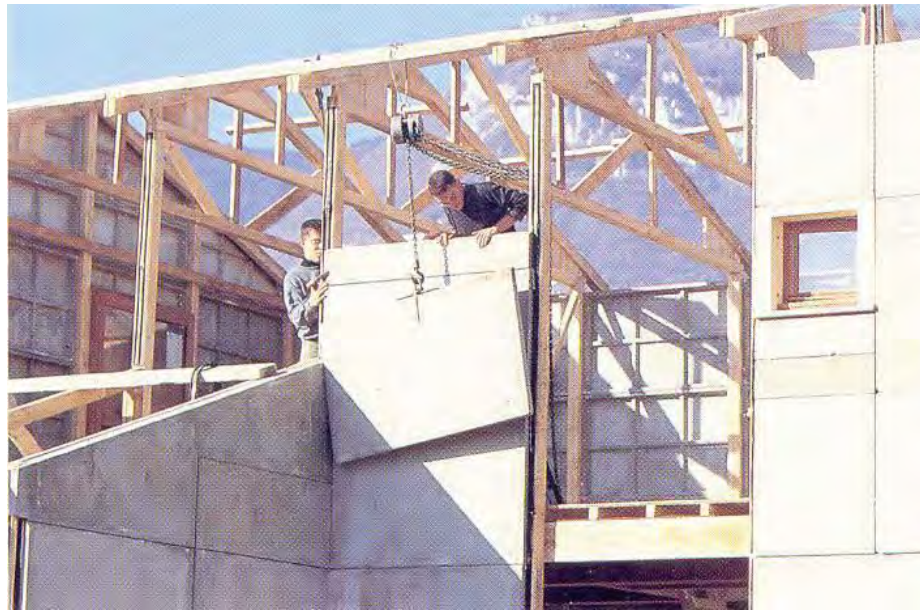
C - EMPLEO DE MUROS CON CIMBRA DESLIZANTE Y PANELES DE CONCRETO DE FORMATO MEDIANO
